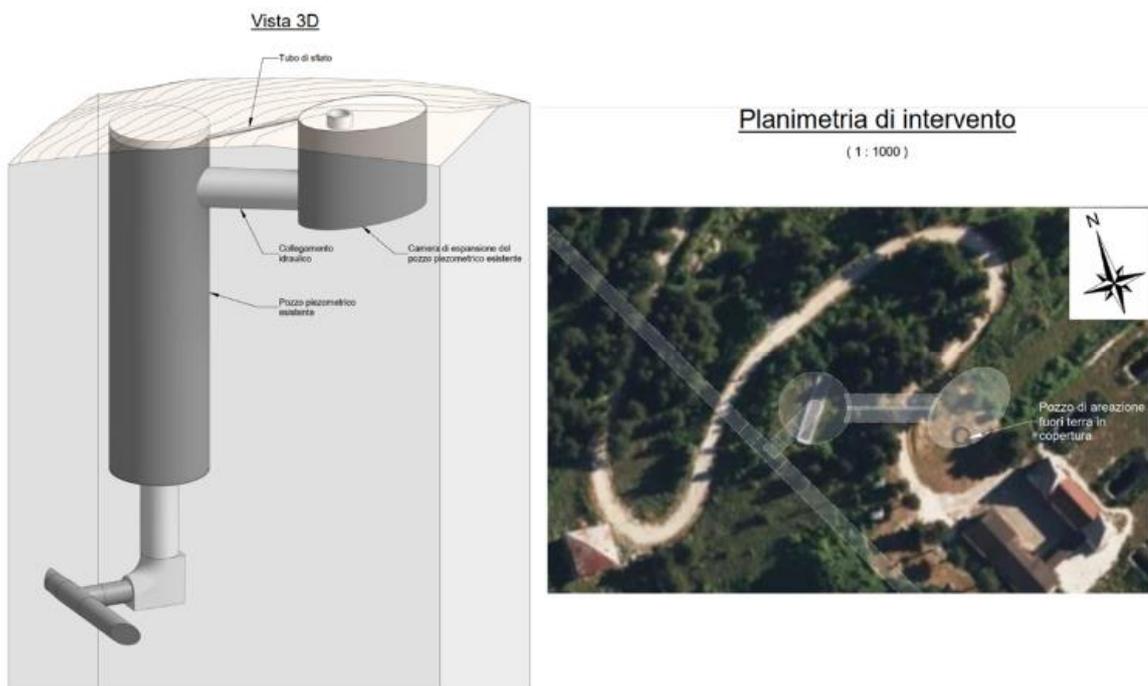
Nuova camera di espansione al pozzo piezometrico sulla derivazione Provvidenza – vista 3D e planimetria d’intervento
